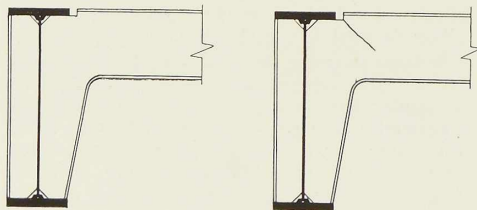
Soudure de l'âme des pièces de pont aux semelles des maîtresses-poutres.
